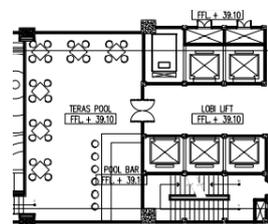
Denah Balok Swiss-Belinn (Puspita, 2017)
